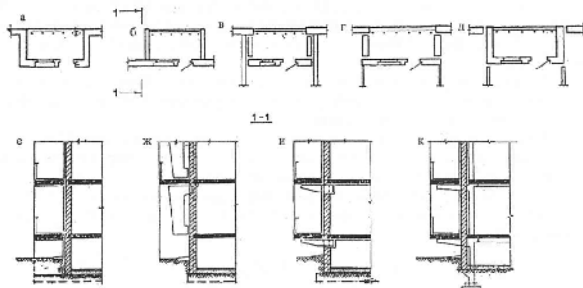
Лоджии: а – вогнутая; б – выпуклая; в – конструкция вогнутой лоджии в панельном здании с поперечными несущими стенами; г – то же, с продольными; д – с использованием объемного блока; е – конструкция выпуклой лоджии на несущих поперечных стенах; ж – то же, на навесных стенах; з – и – на консольных балках; к – на консольных колоннах
